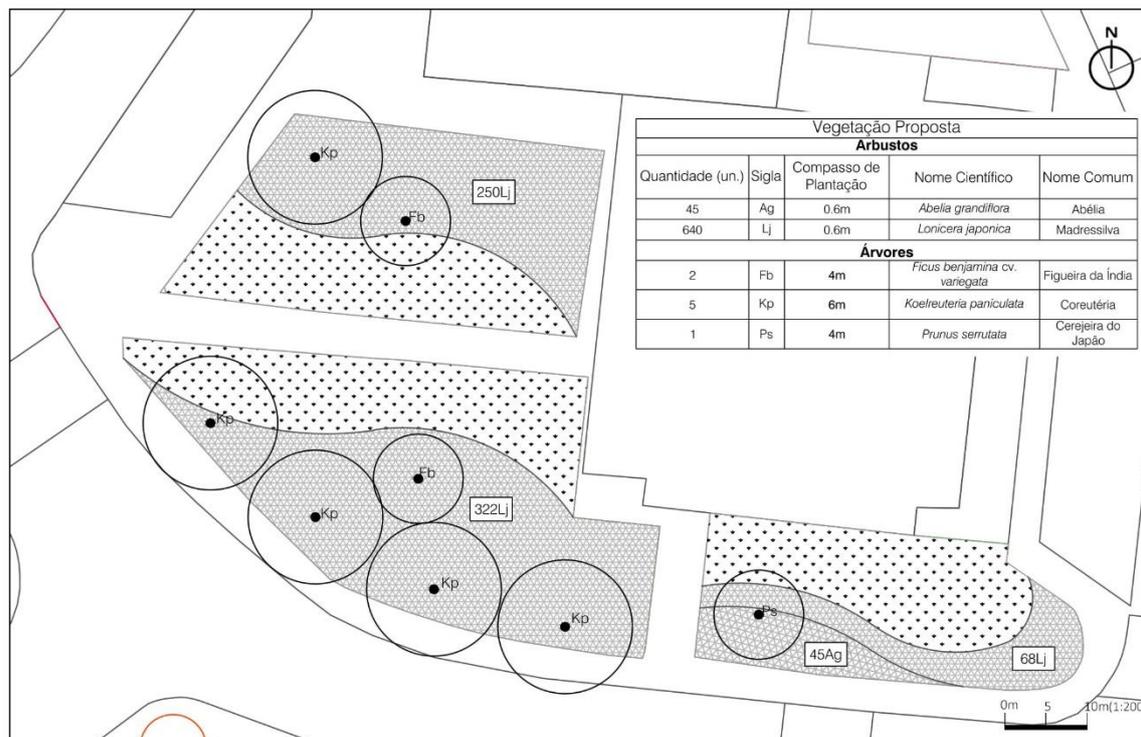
Plano de Plantação (Ver Anexo C) (Fonte: Autor)
